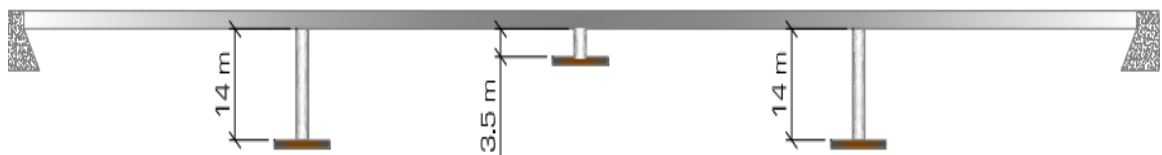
Modelo Irregular, pila extrema mayor que pila central.
